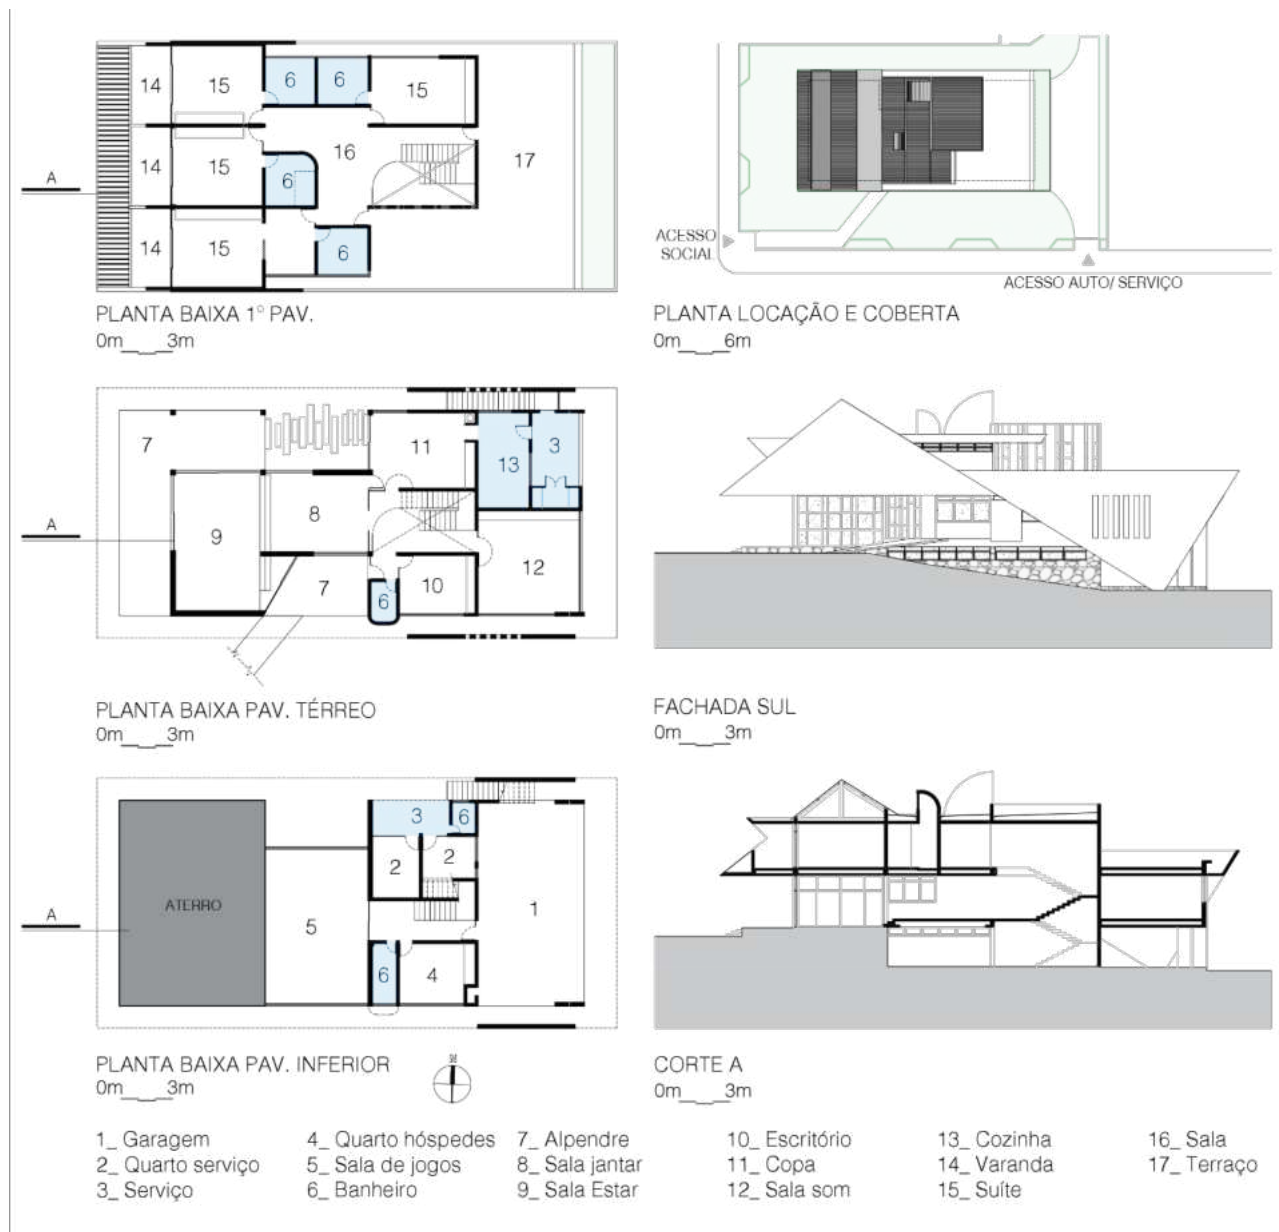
Plantas, fachada e corte da Res. Walter Brito. Fonte: Acervo GRUPAL-UFCG, modificado pelo autor.
